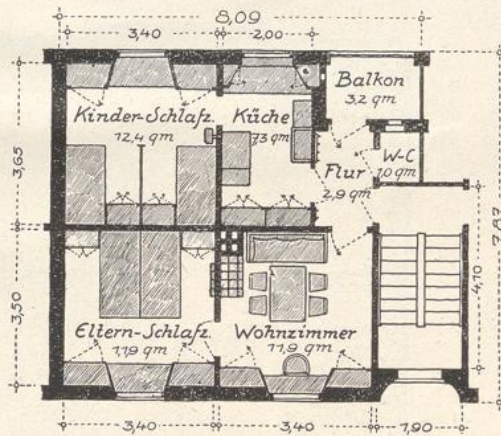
Etagenwohnung im Reihenhause mit eingebauten Kastentmöbeln (1:150)
